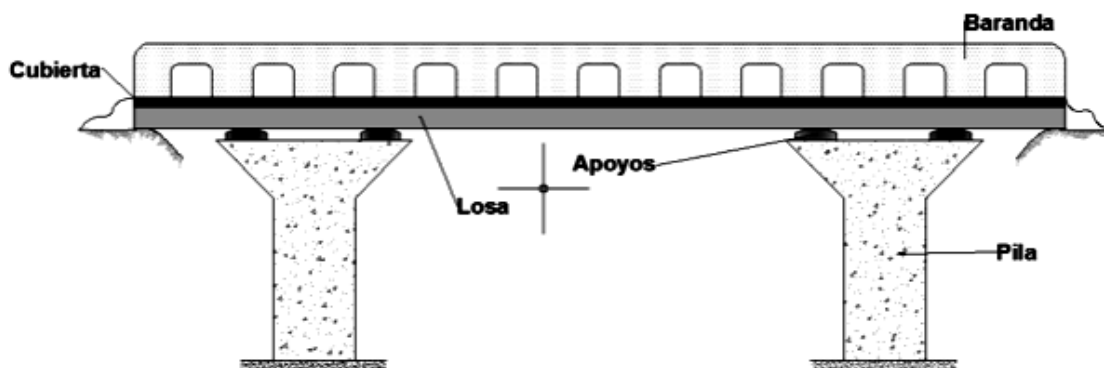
Ejemplo de puente de losa apoyada en pilas de concreto. (Editado en AutoCAD)
